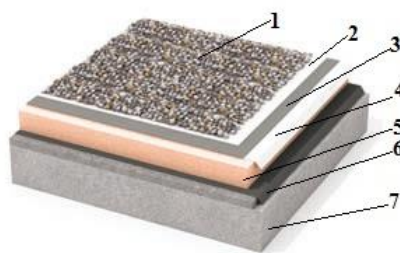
Система балластной кровли TN-Кровля Балласт: 1 — балласт; 2 — подкладочный слой (геотекстиль); 3 — полимерная мембрана; 4 — разделительный слой (стеклохолст); 5 — XPS-плиты; 6 — пароизоляция; 7 — несущее основание
